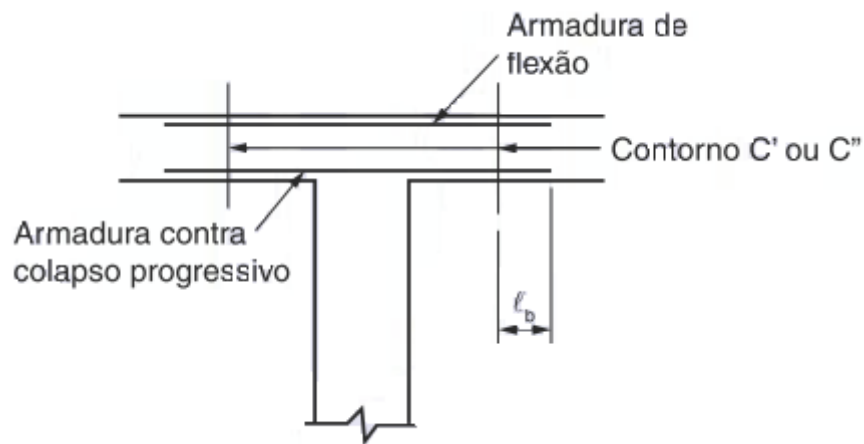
Armadura contra colapso progressivo (NBR 6118,2014)
